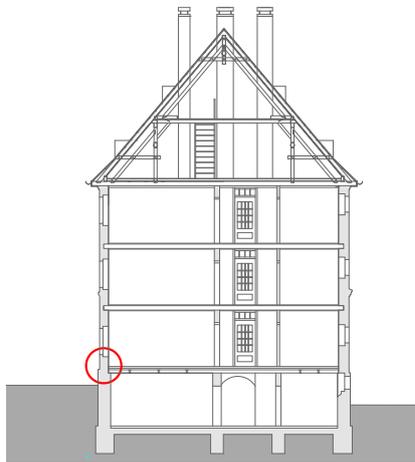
Sockeldetail Bestandssanierung mit Innendämmung
